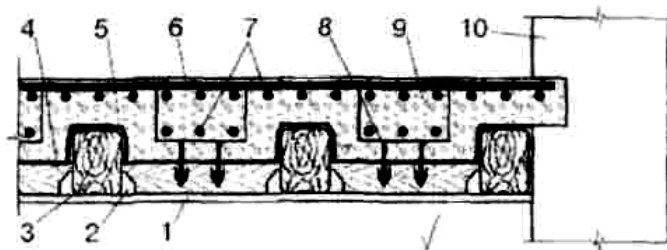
Конструктивна схема влаштування нового залізобетонного перекриття із застосуванням в якості опалубки старого дерев'яного перекриття:
